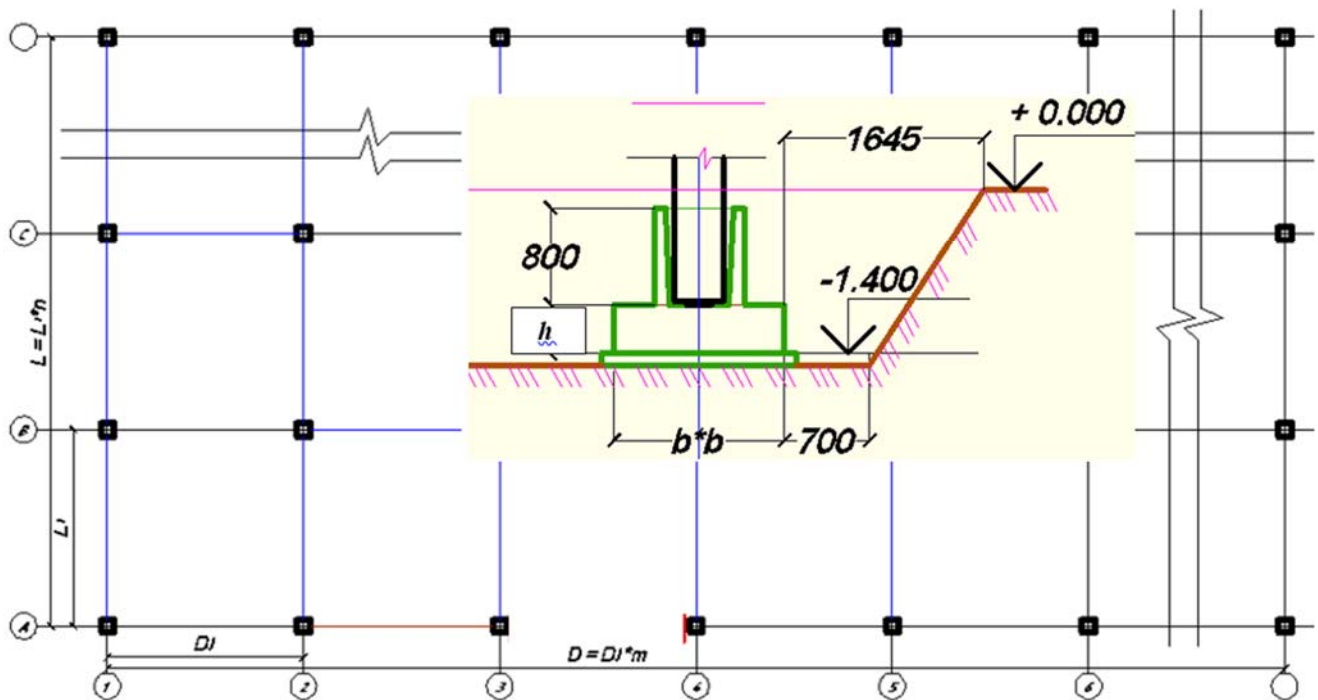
Схеми каркасної будівлі для вибору завдання на проектування
